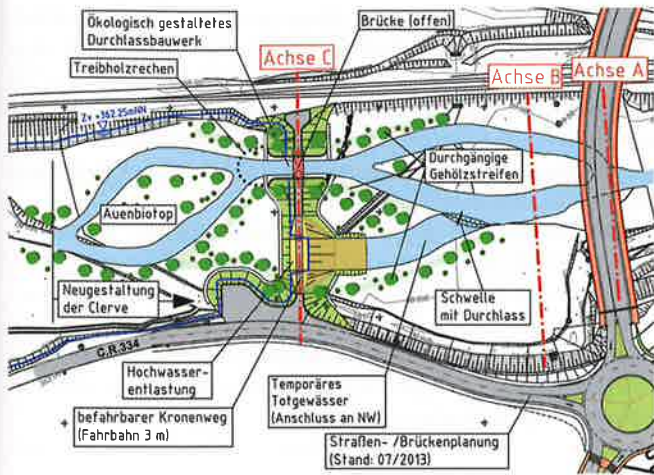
Lageplan des HRB in Bauwerksachse C (Vorzugsvariante) mit Neubaustraße und -brücke und linkerseitiger Bahntrasse
